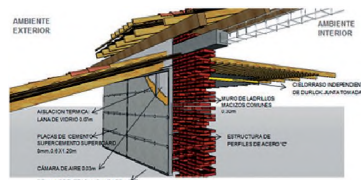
propuesta de muro ventilado sobre fachada oeste del sector antiguo de la FAU
